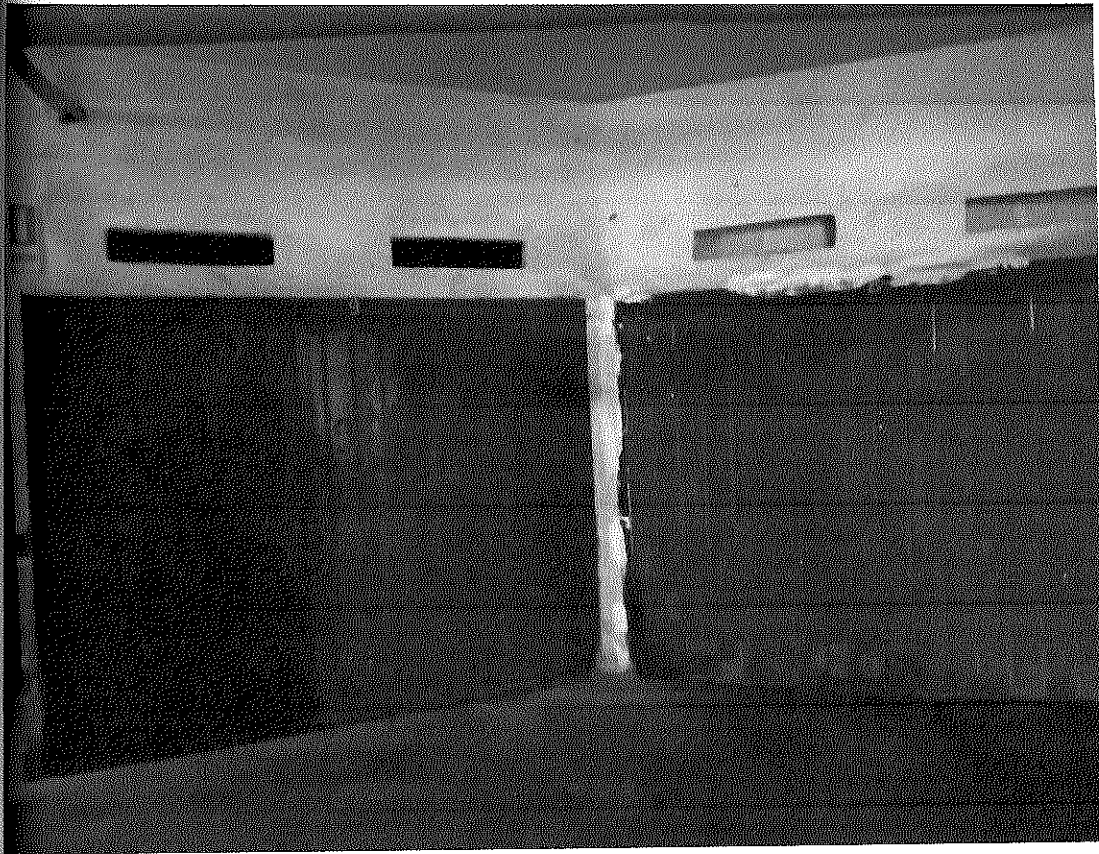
Vista della porta di accesso al box oggetto di stima distinto con il numero 9
